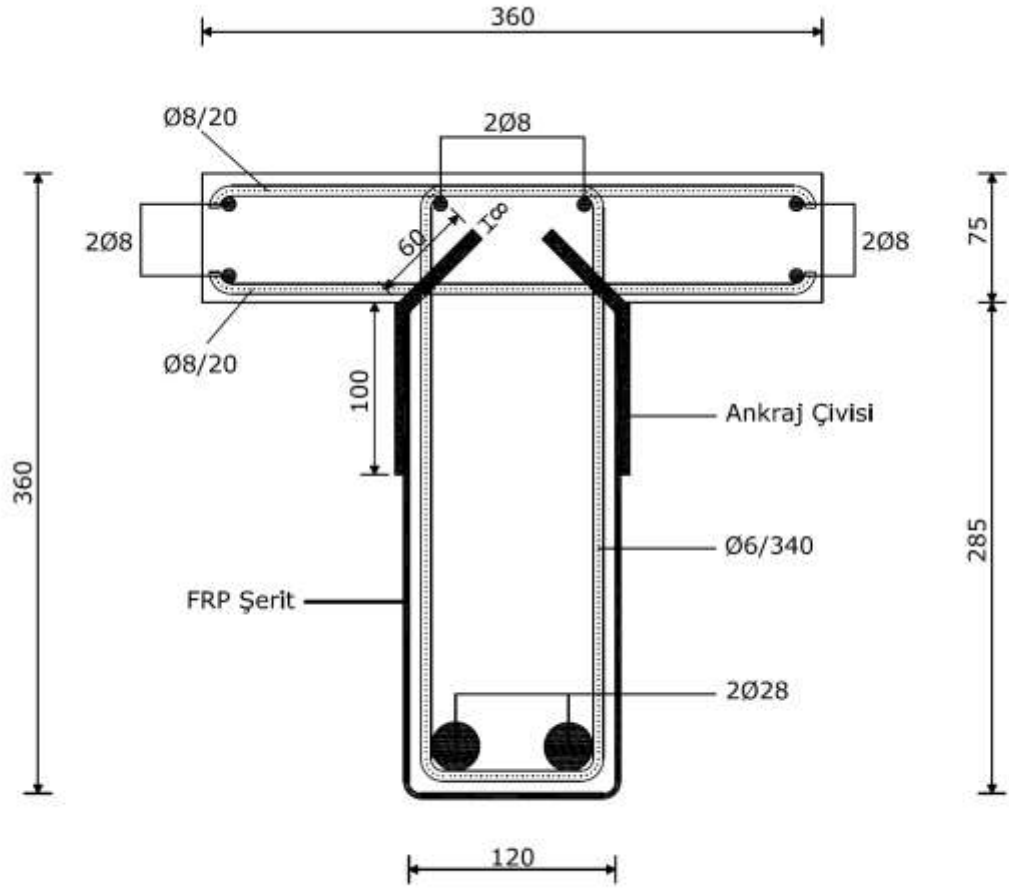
Güçlendirmede kullanılan FRP liflerin kesit planı
